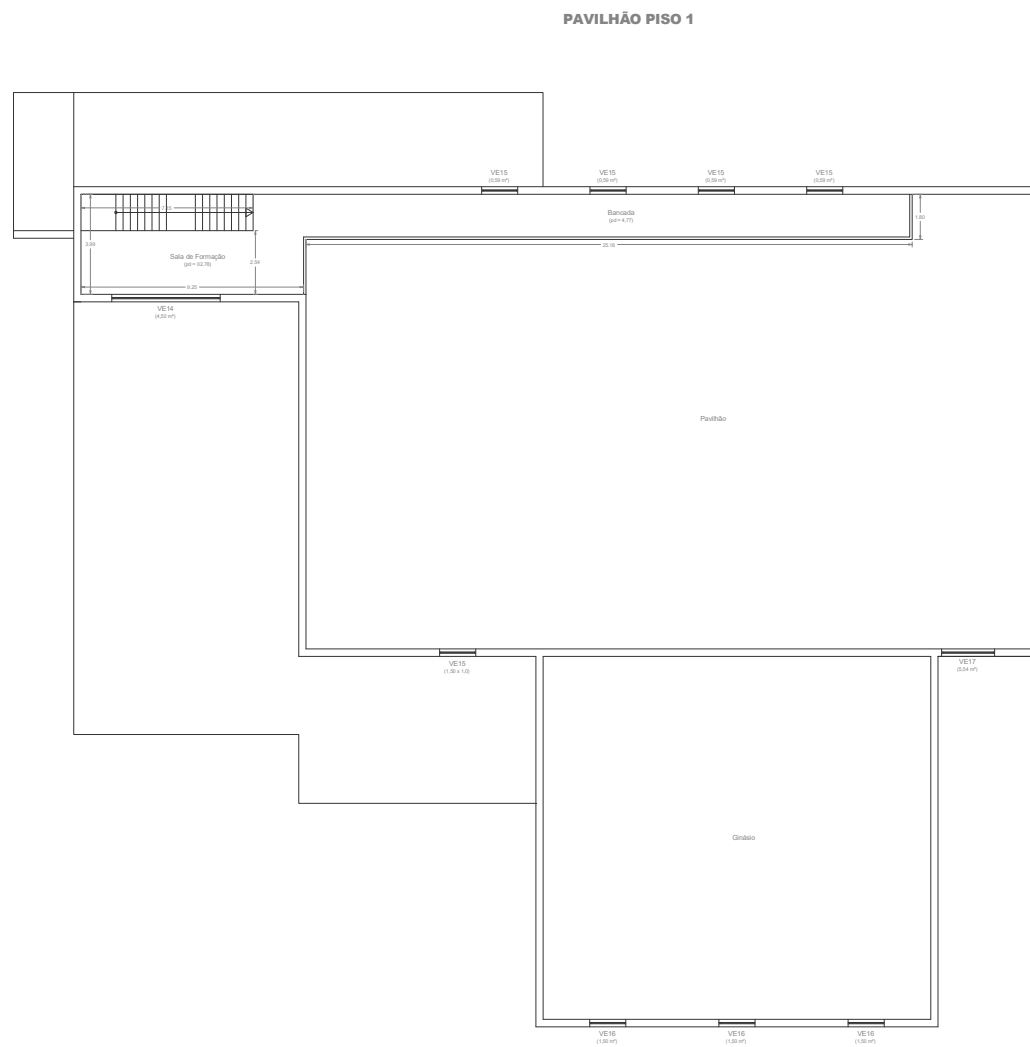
Desenho 2D do levantamento dimensional e geométrico do Piso 1 do Pavilhão.
